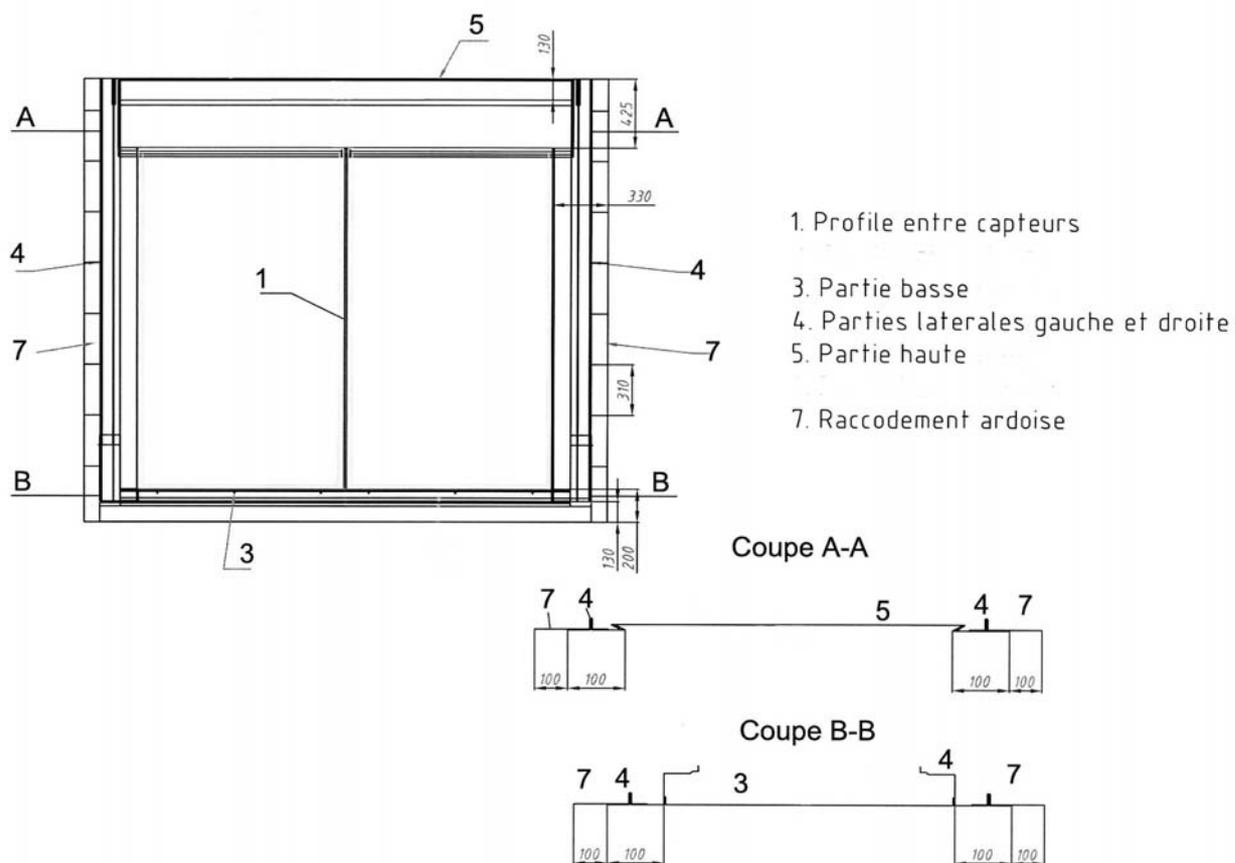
Implantation dans une toiture en tuiles plates ou en ardoises– vue en plan
